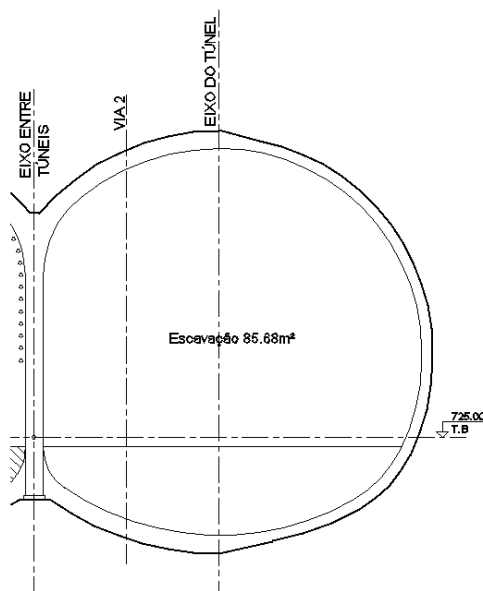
Área de escavação seção conforme projeto executivo - Fonte: Projeto Executivo
